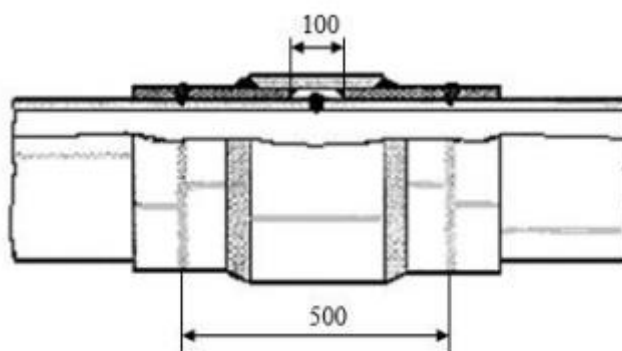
Муфта галтельная сварная типа П5
